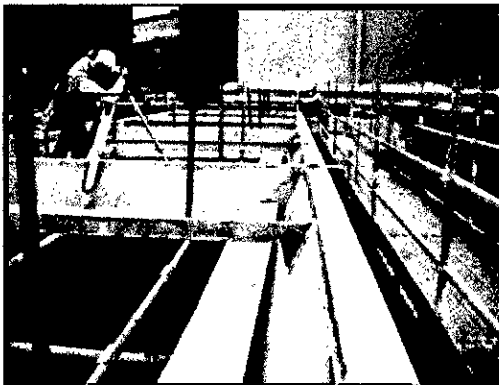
Avance de montaje mecánico de las estructuras del Filtro de Mangas
